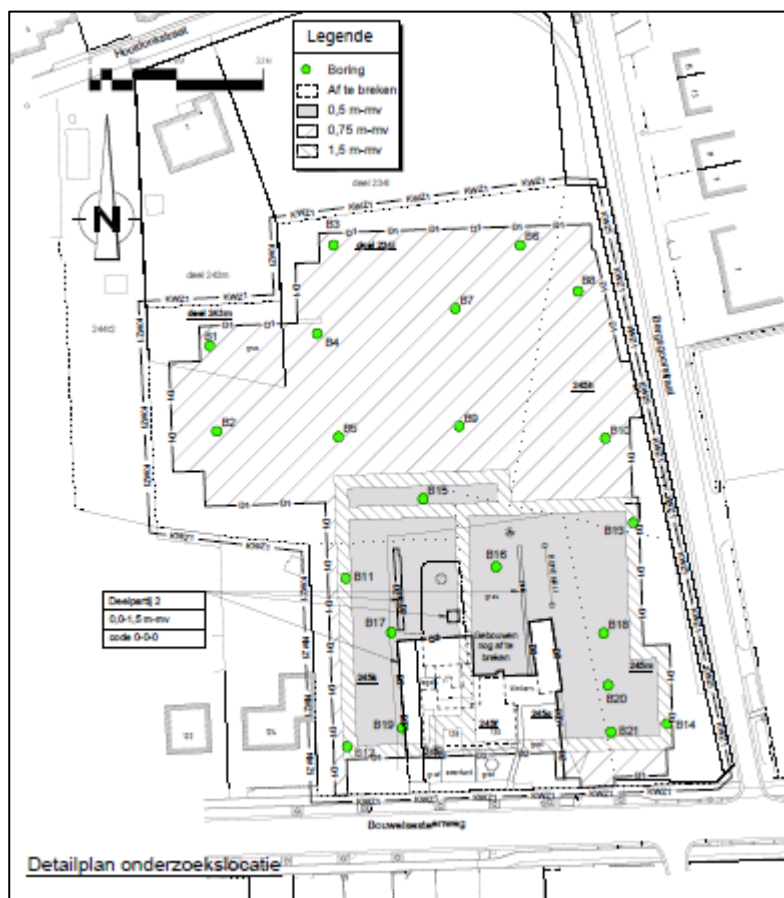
Grondplan van de bestaande toestand binnen het plangebied.
